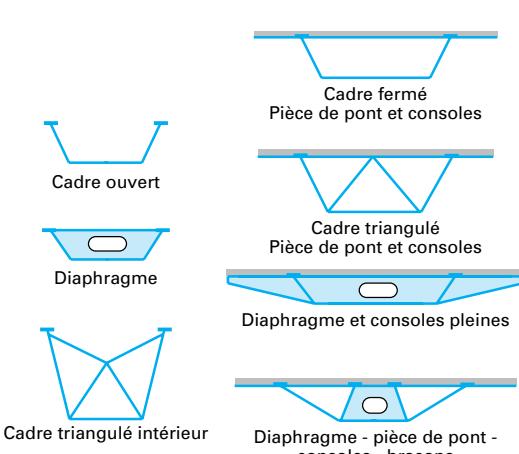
Formes d'appuis de la dalle et d'entretoisement d'un caisson mixte
